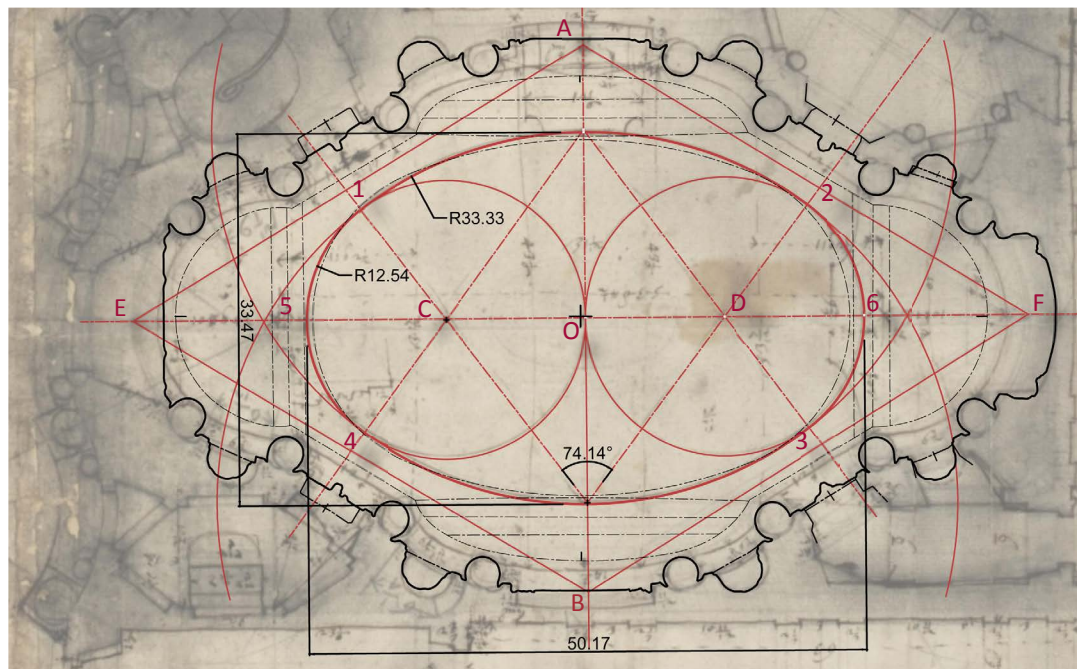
Sovrapposizione del disegno AZRom170 con la costruzione geometrica dell'ovale, la pianta di rilievo e la proiezione della cupola.
